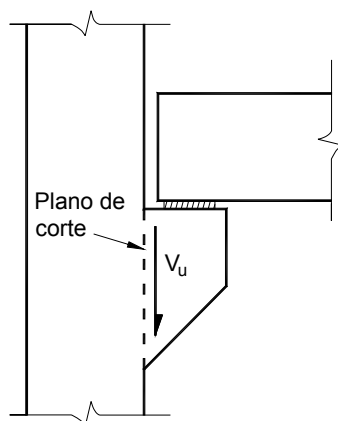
Plano de corte crítico para ménsulas y cartelas
